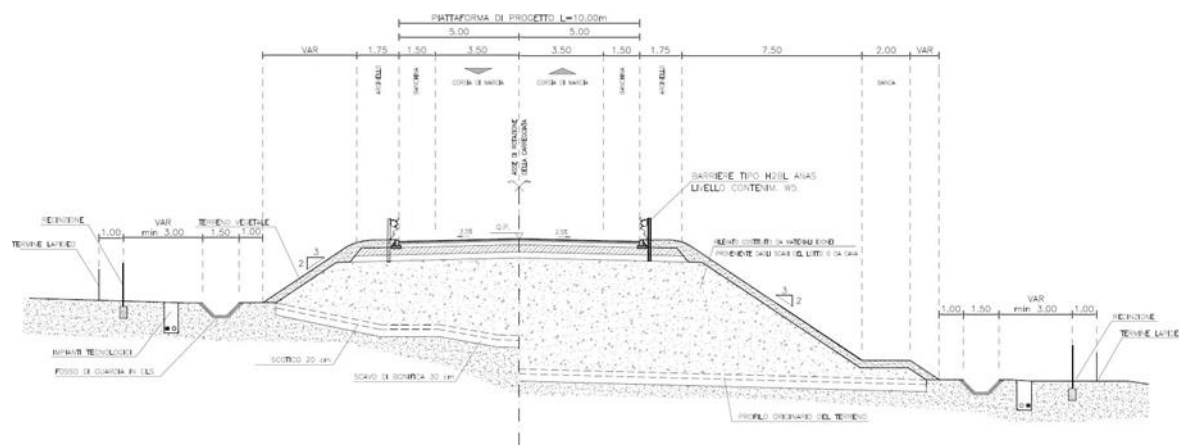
Sezione tipo rampa bidirezionale in rilevato.
